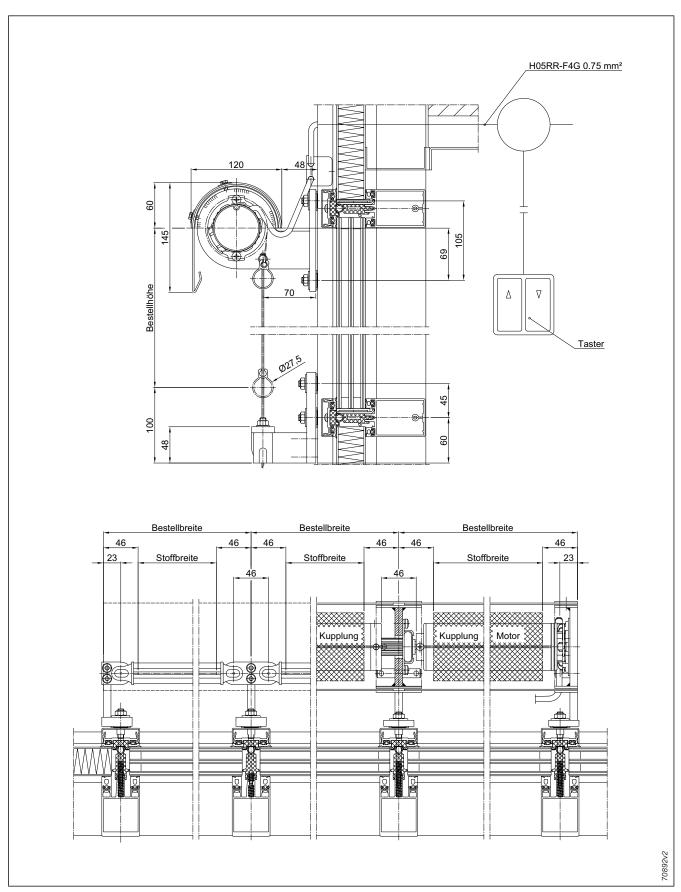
Fassaden-Markise 209 mit Halbrundblende Typ 20.3 und Spannseil
